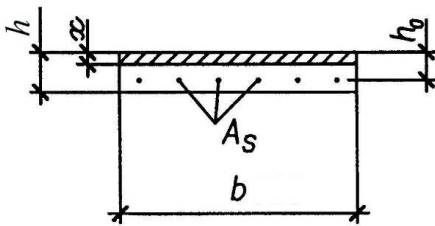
Расчетное поперечное сечение балочной плиты: b – ширина расчетной полосы балочной плиты, мм; h и h_0 – высота поперечного сечения балочной плиты и ее рабочая высота, мм
